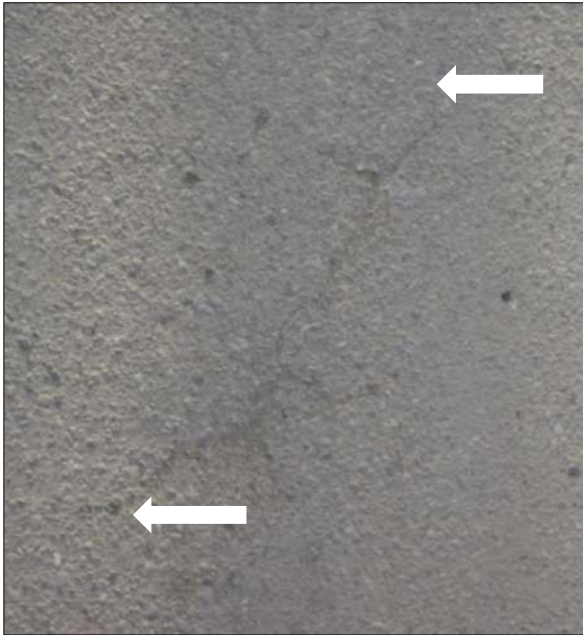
Fisuras longitudinales y transversales de severidad bajo
